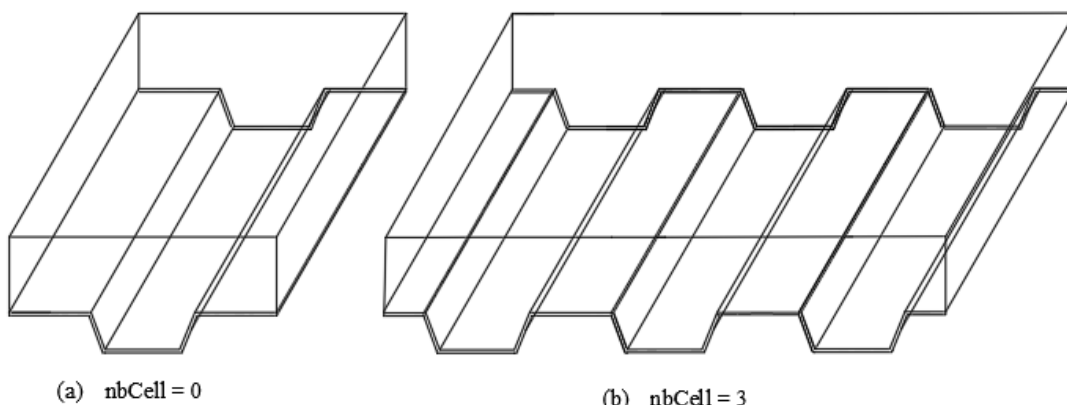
Parâmetros para dimensionamento das nervuras da laje mista MATLAB
